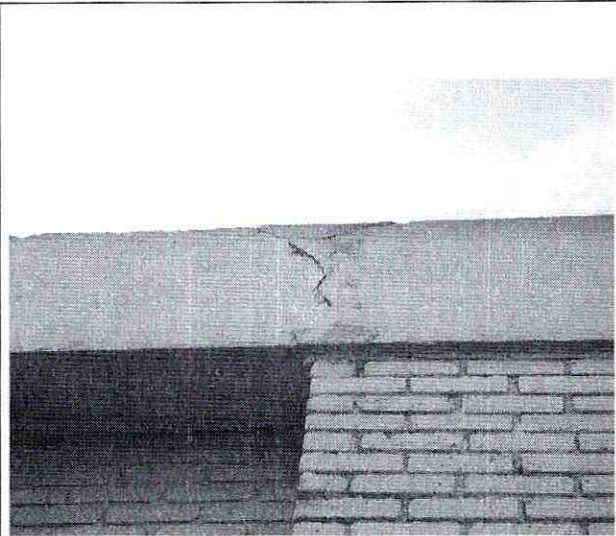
Agrietamiento en el antepecho interno que remata el muro; corresponde a la prolongación de la grieta vista en la Foto 5.
